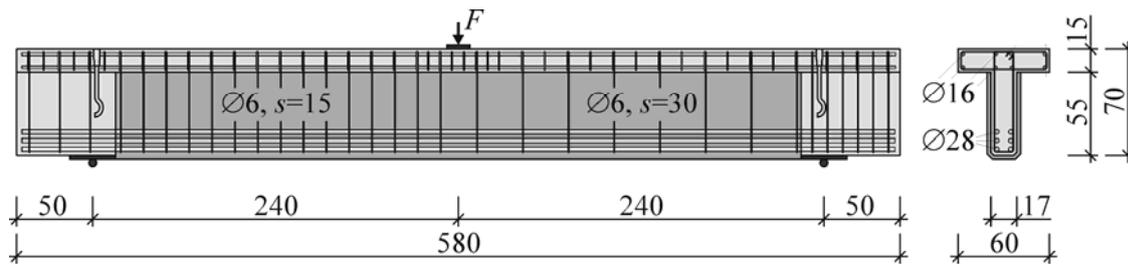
Querschnitt der verstärkten Probekörper und Bewehrungsführung
